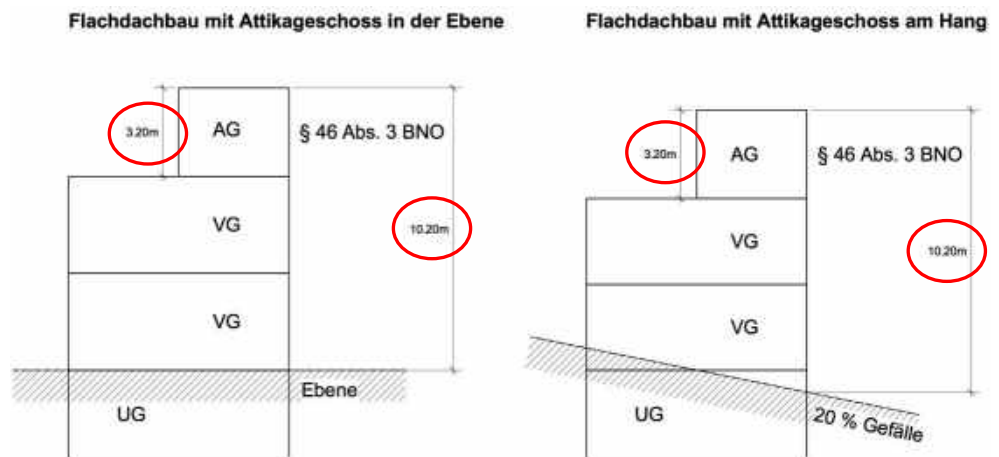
Masse und Messweisen der Fassadenhöhe Flachdachbau mit Attikageschoss (Quelle: PLANAR, 2018)
